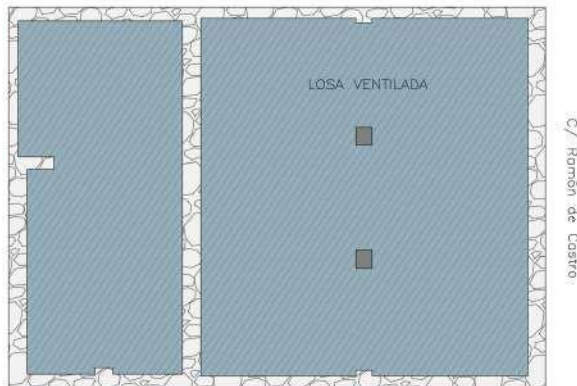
Distribución de la losa ventilada vivienda. Fuente propia
